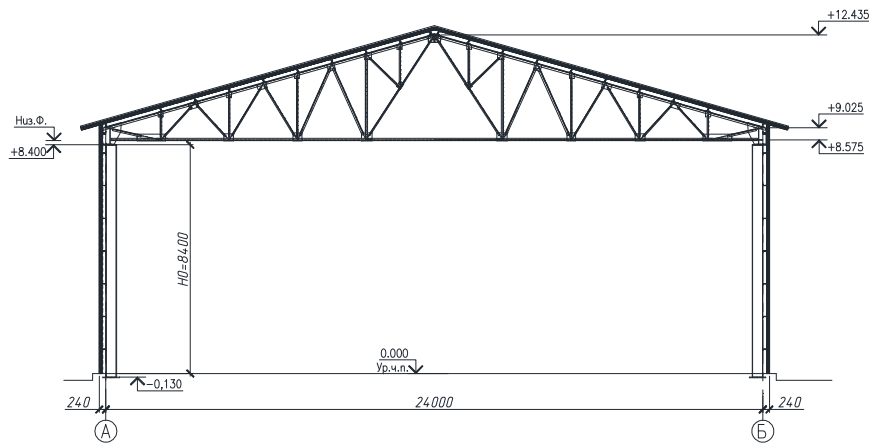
Схема поперечної рами каркаса будівлі.
